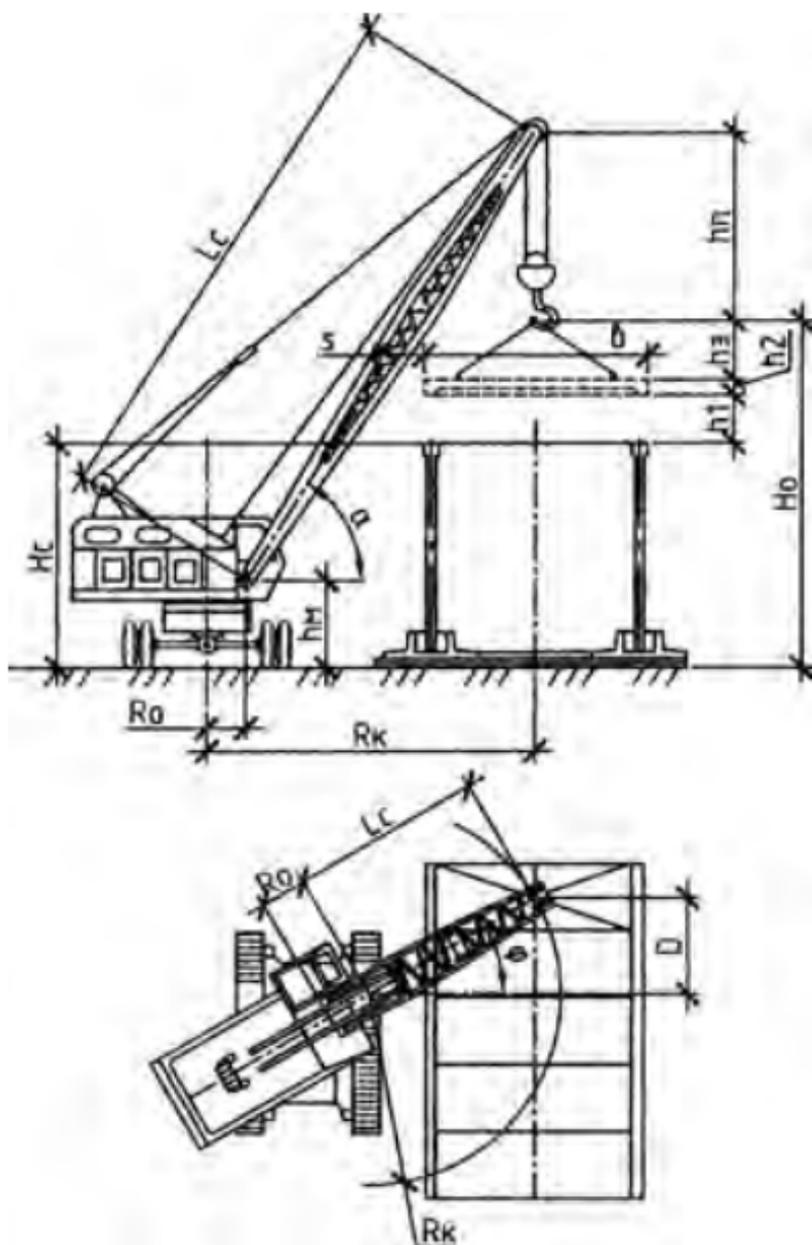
К определению расчетных параметров при выборе монтажных кранов
